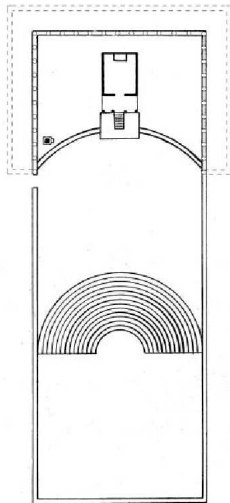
ricostruzione planimetrica del complesso di via Malta (da Bonetto 2006, fig. 7)
